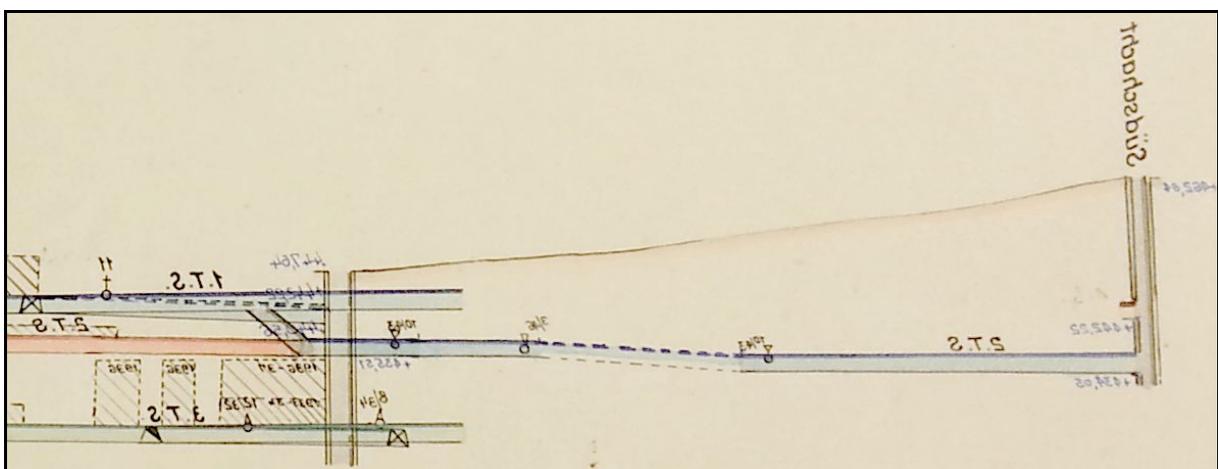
Seigerriss gespiegelt (zum Vergleich mit Lageplan)
